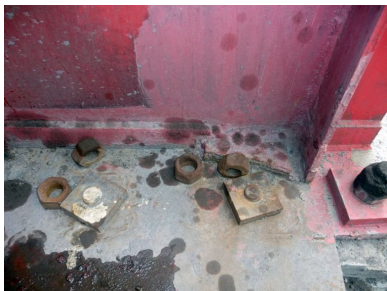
Фрагмент крепления трубы к фундаменту с разорванными анкерными болтами
